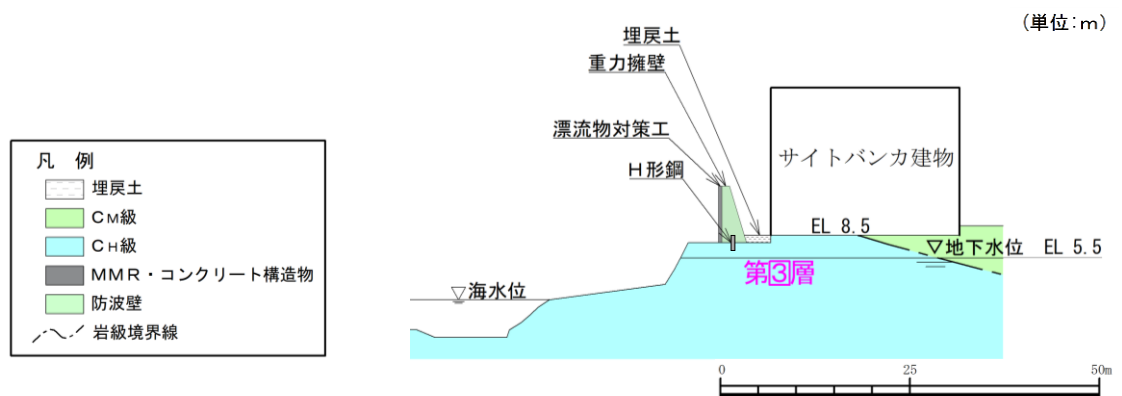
地質断面図 (⑤-⑤断面)
